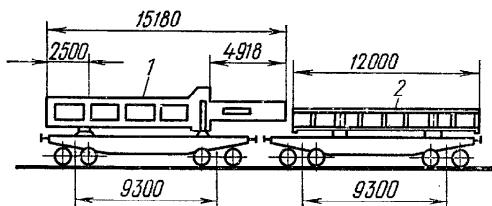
Схема погрузки конструкций на цепи из двух платформ:
